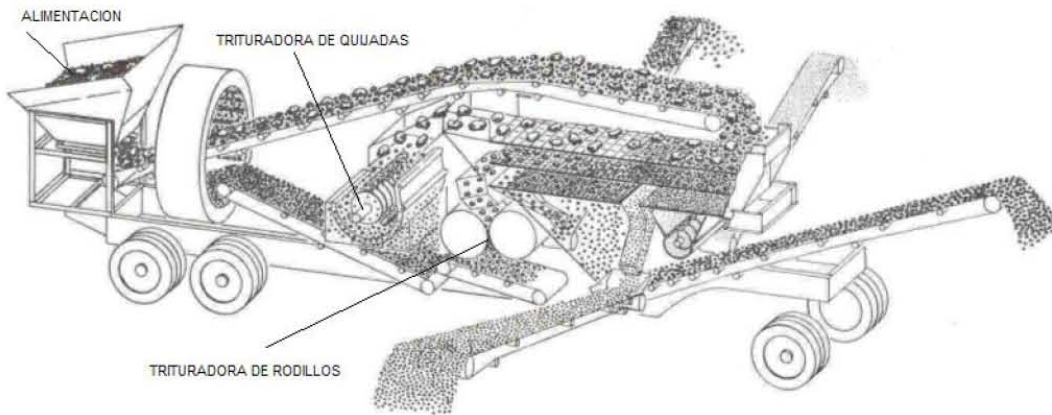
Diagrama de flujo de una planta dual con trituradoras primaria de quijadas y secundaria
